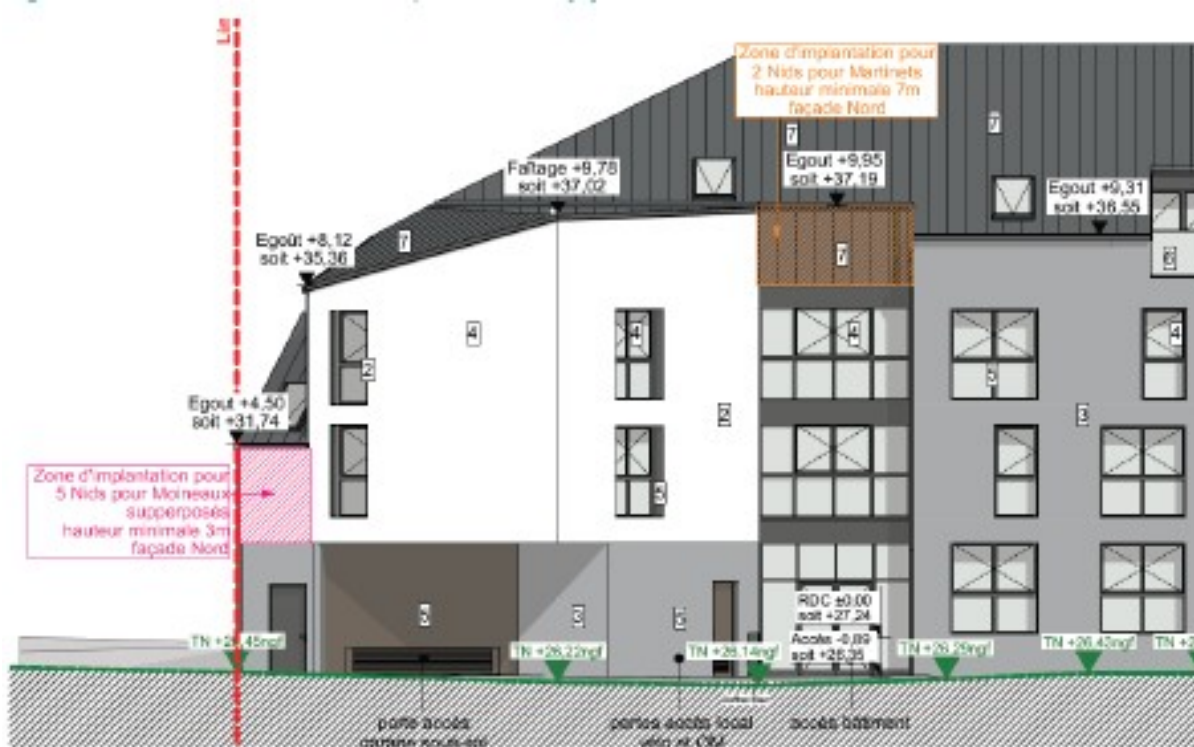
Zoom du plan de façade nord localisant les mesures de compensation, sur la base de nichoirs triples - PRISM architectes associées
